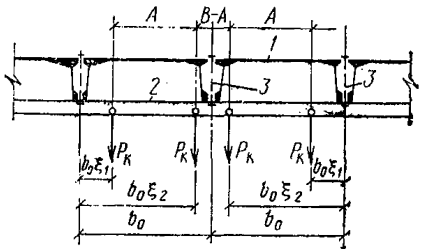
Схема нагружения покрытия подвесными кранами при определении максимальной нагрузки на диафрагму
